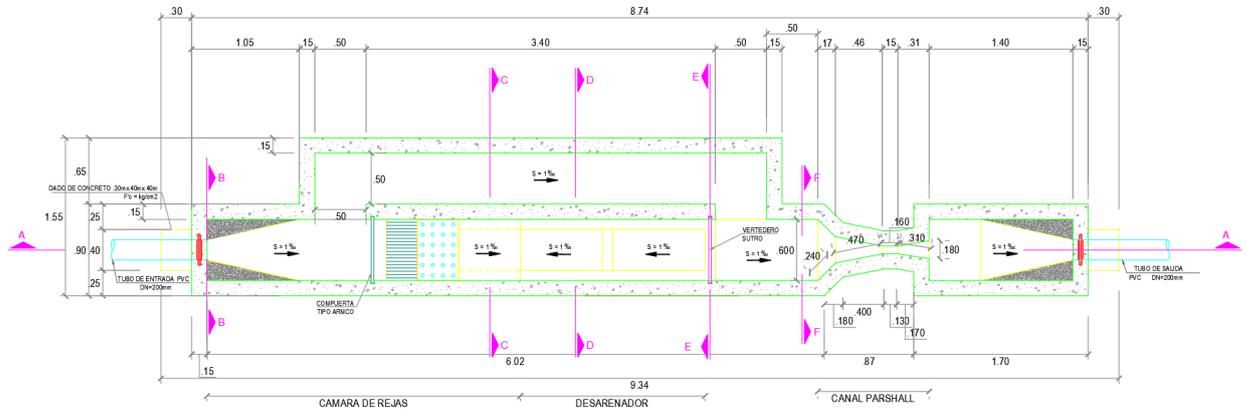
Planta de Cámara de Rejas, Desarenador y Canal PARSHALL
